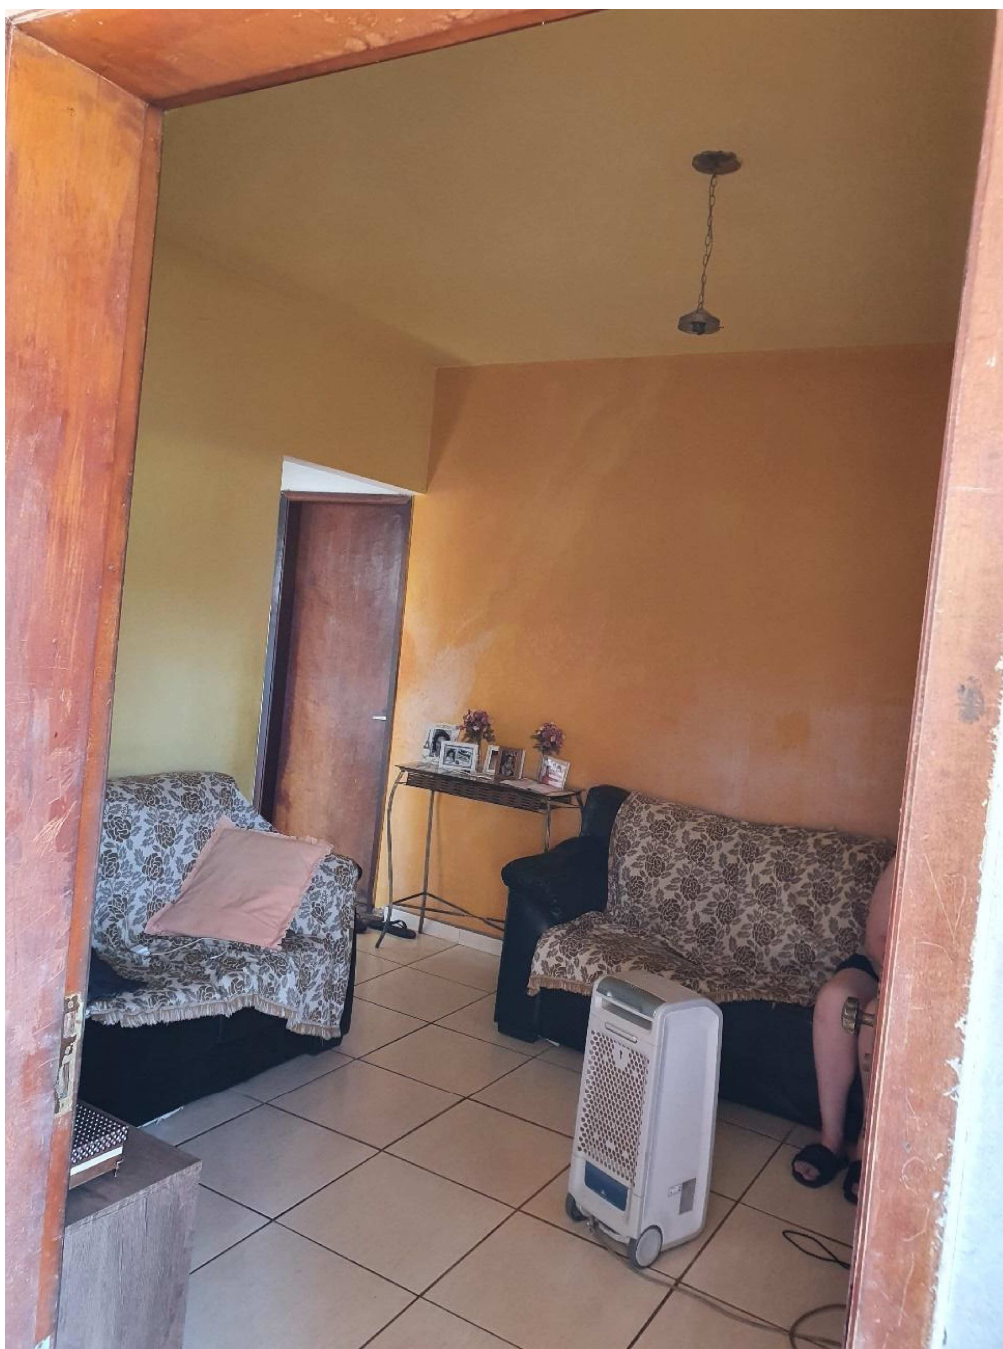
Detalhes de infiltração, rachaduras na parede, divisa com o quarto I e na laje em toda a sua extensão.
